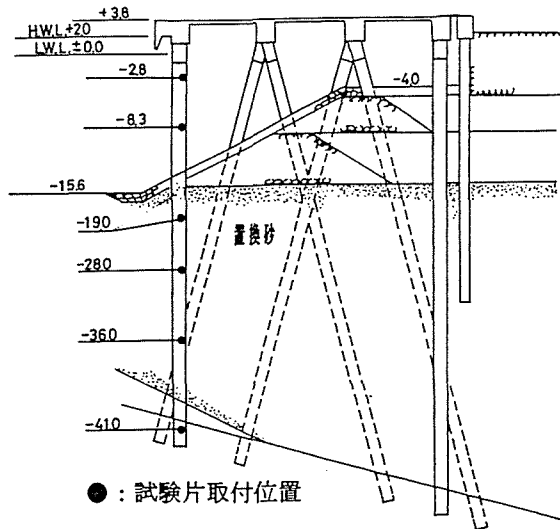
8 栈橋断面図および試験片の取付深度 (m)
